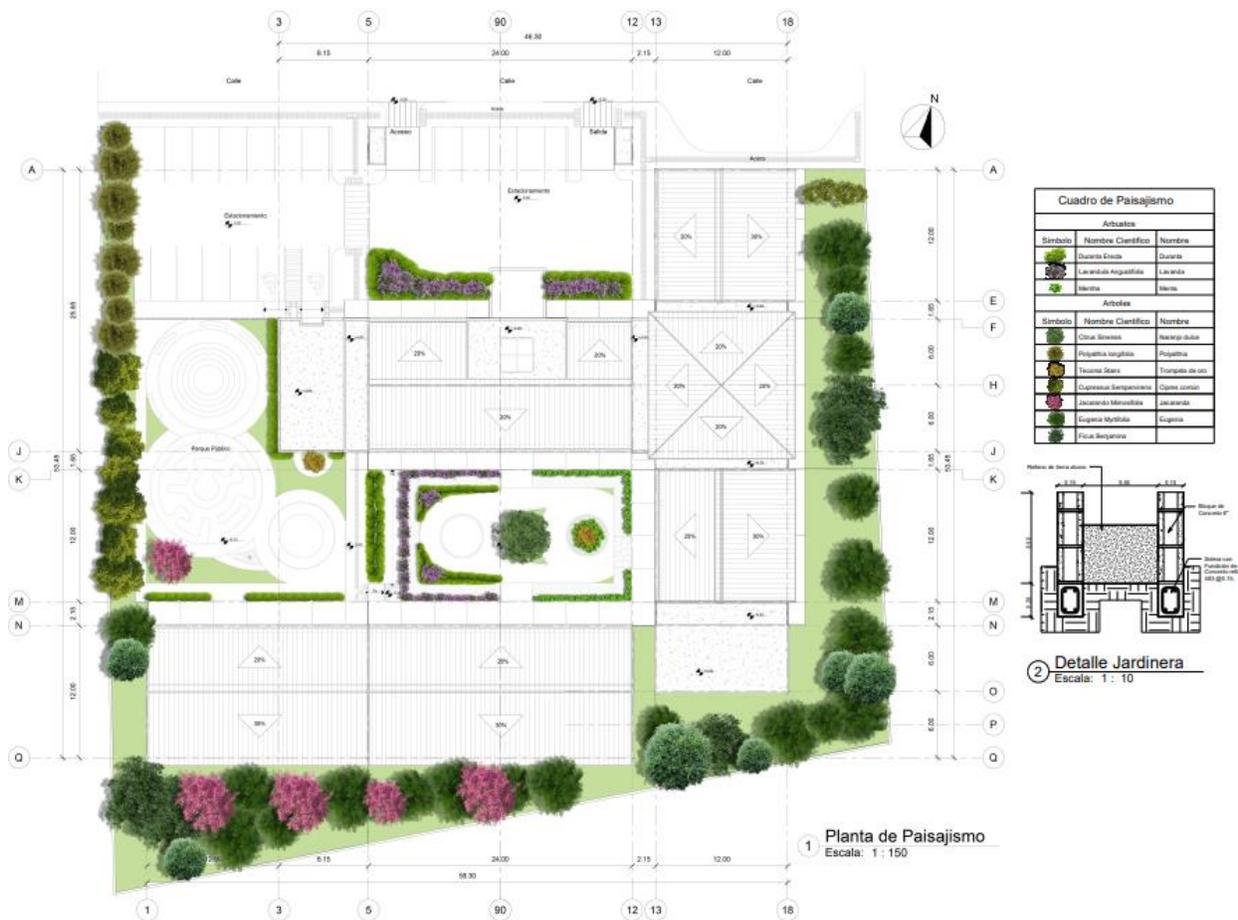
Planta de paisajismo. Fuente: Elaboración propia
